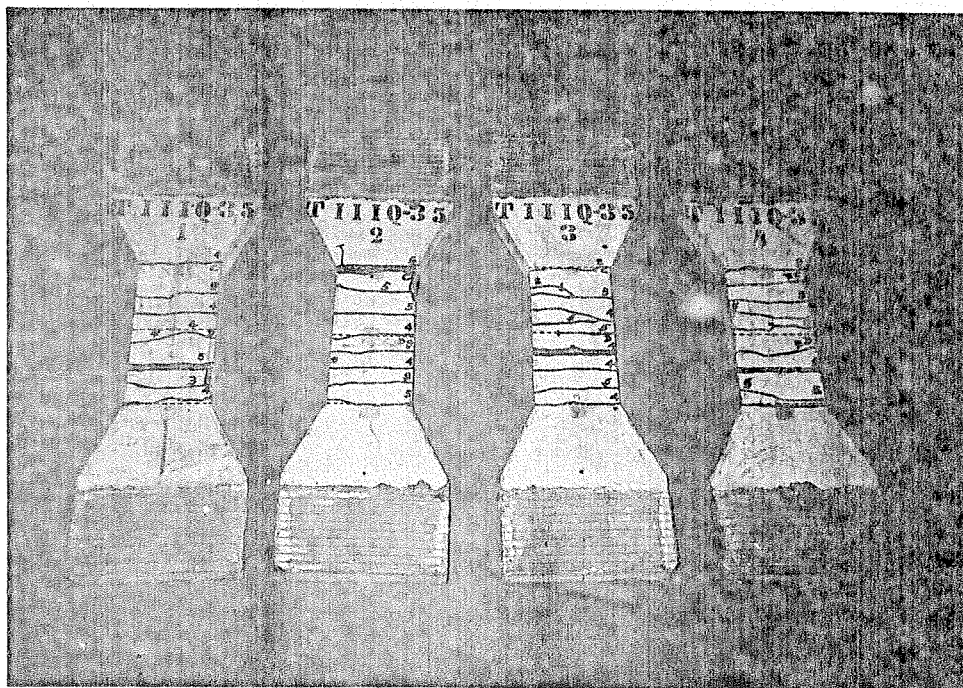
Fissuração final - Série T111035 (face 2 - regiões C e D)
